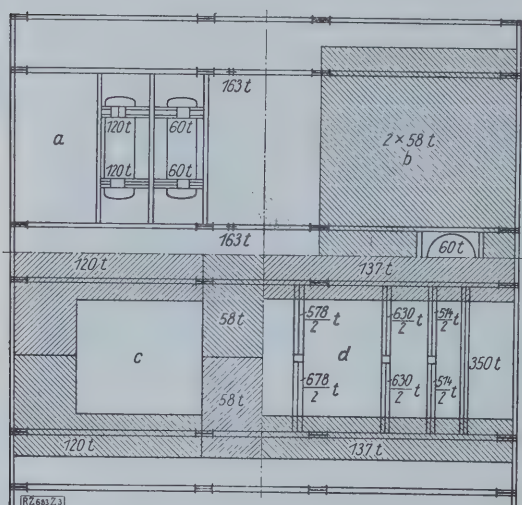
Teil des Kesselhaus-Grundrisses mit eingezeichneten Lasten.
